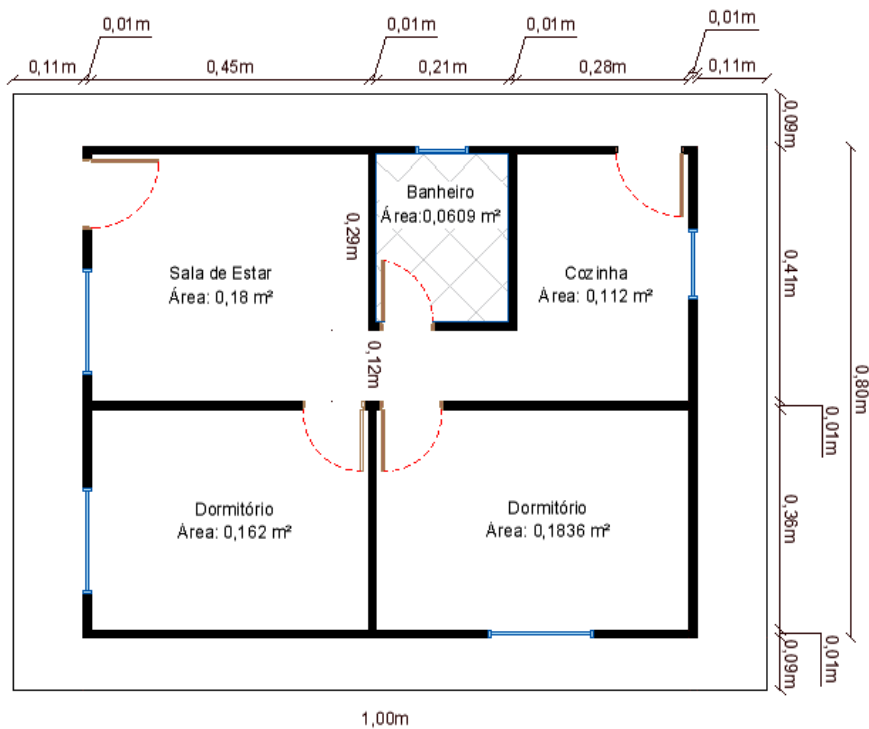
Planta baixa dos protótipos de habitações de interesse social.
